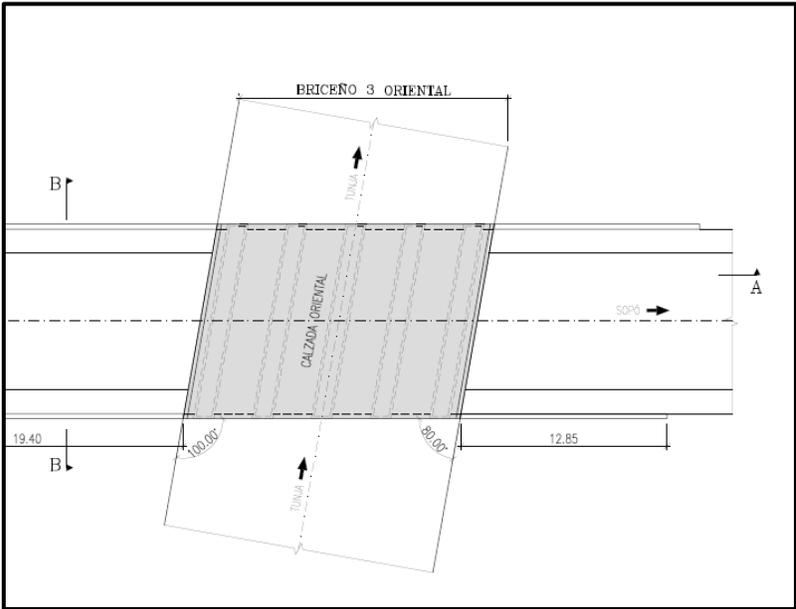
Vista en Planta Deprimido Briceño 3 Oriental
